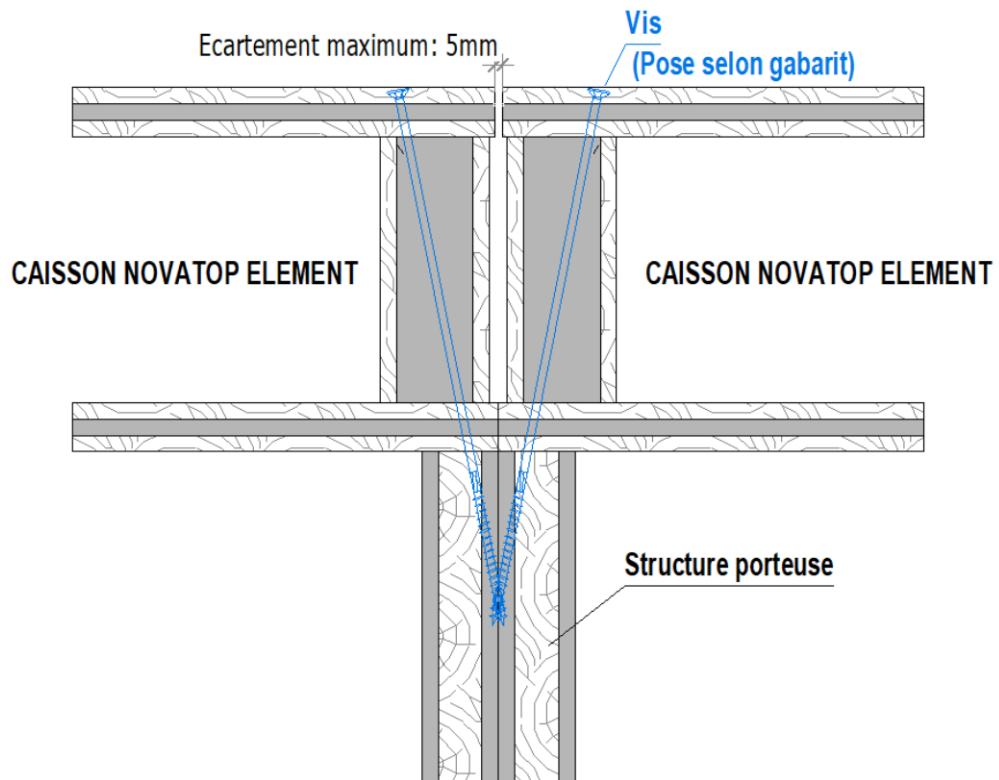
Fixation sur muraille retroussée (non applicable en situation sismique)
